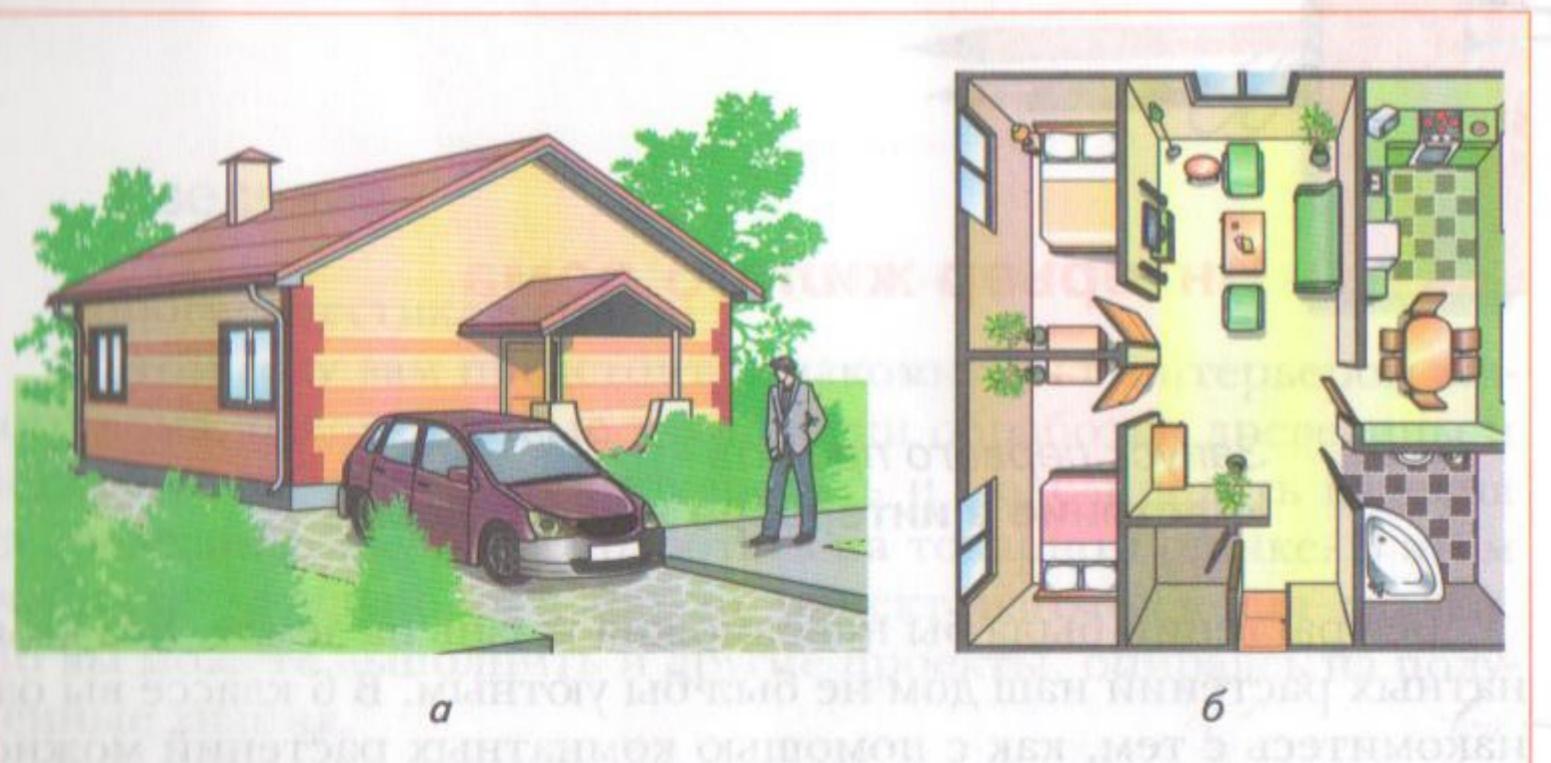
Общий вид (а) и планировка (б) одноэтажного жилого дома (вид сверху)
